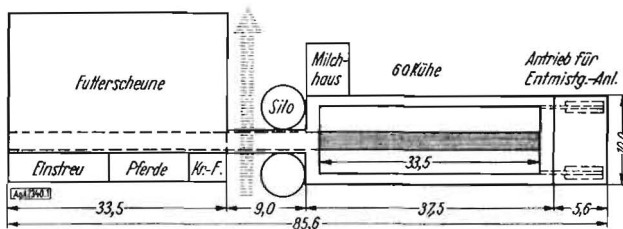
Grundriß eines Kuhstalles mit fahrbarem Futtertisch in Schweden
